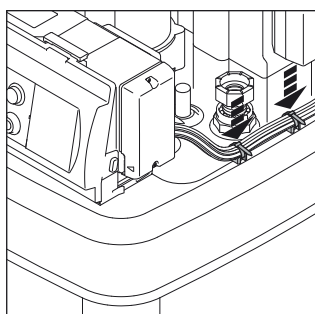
Fissare i cavi al serbatoio ad accumulo.
